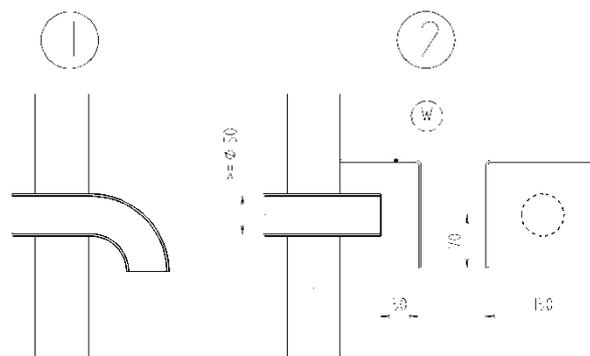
Protection contre le vent du conduit d'aspiration d'air
